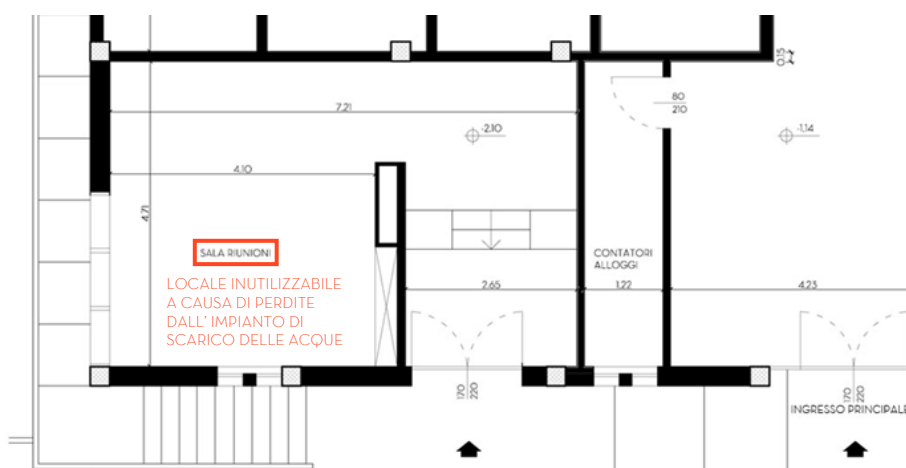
, Porzione Pianta Piano terra con vista dell'ex sala riunioni. Tavola SF 13
